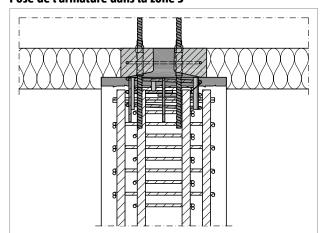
Schöck Sconnex® type P : pose de l'armature dans la zone 3 – coupe longitudinale du poteau
